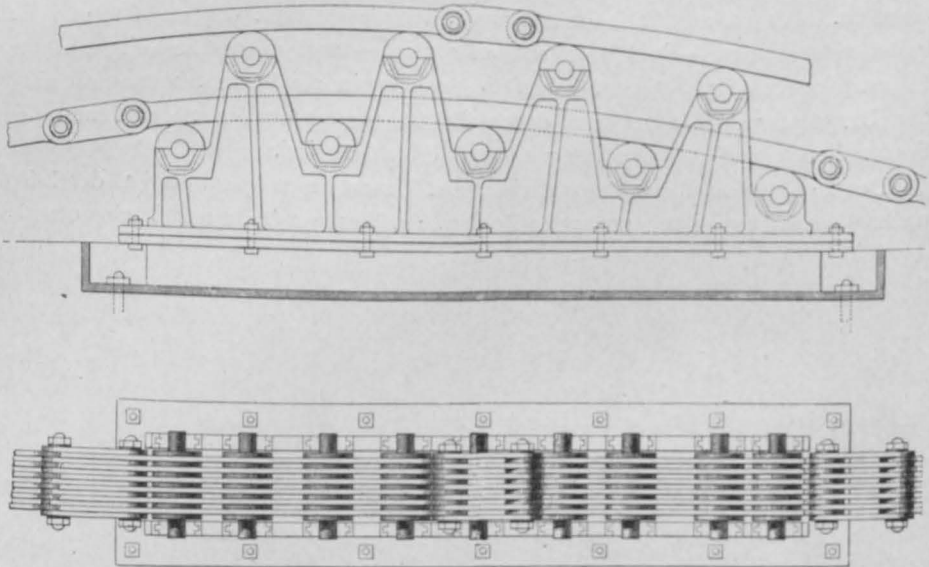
Lagerung der Ketten auf dem Mittelpfeiler der Hammersmithbrücke.
